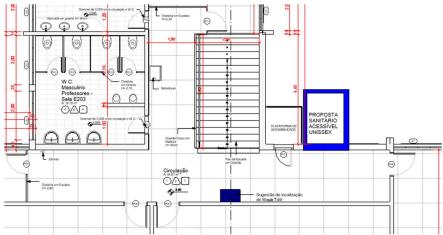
Proposta sanitário acessível e localização Mapa tátil, 1° pavimento.
